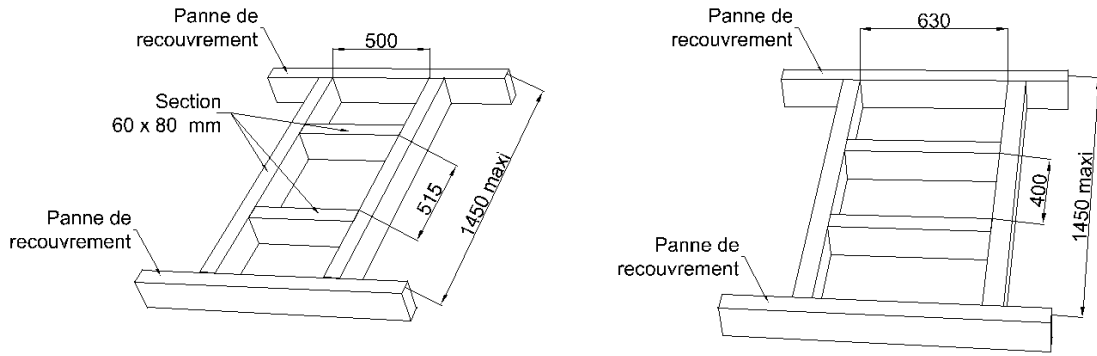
Dimension chevêtre pour plaque à châssis et plaque VMC
